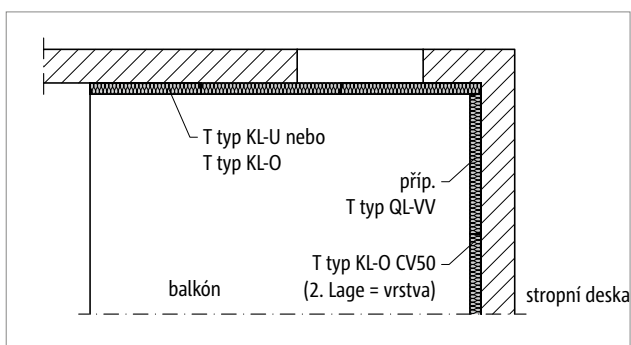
Schöck Isokorb® T typ KL-U/KL-O: Volně vyložený balkón
